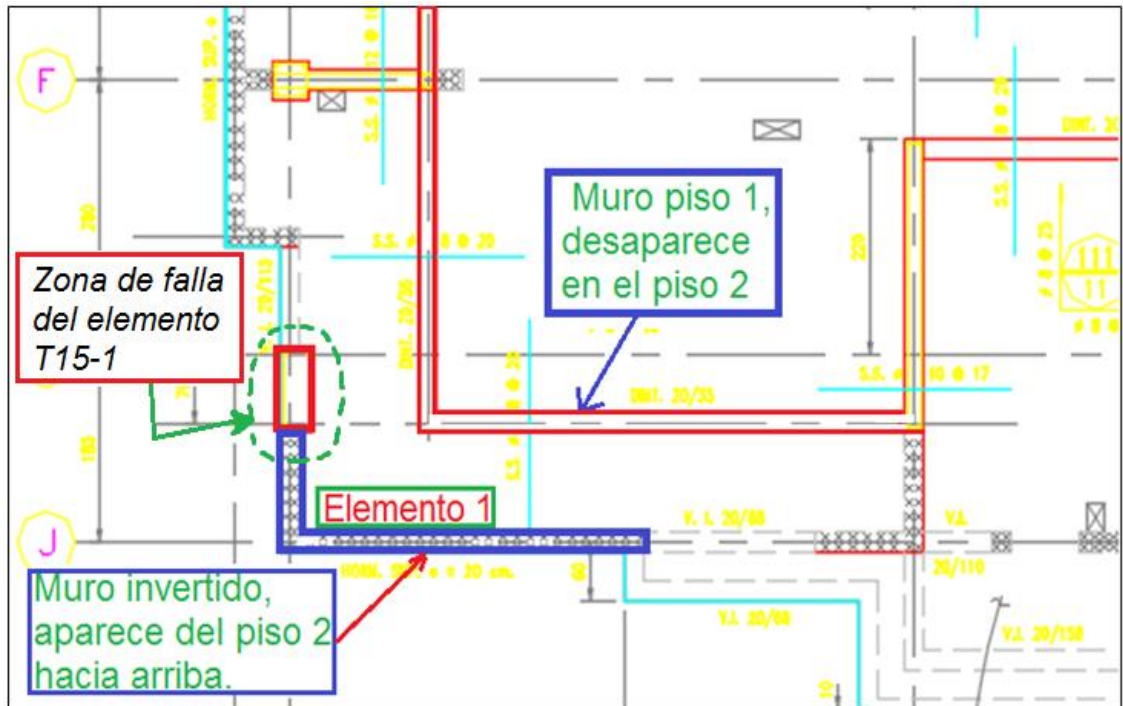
Elemento fuera del plano vertical, vista en planta piso 1 del edificio T15 (elemento 1)
